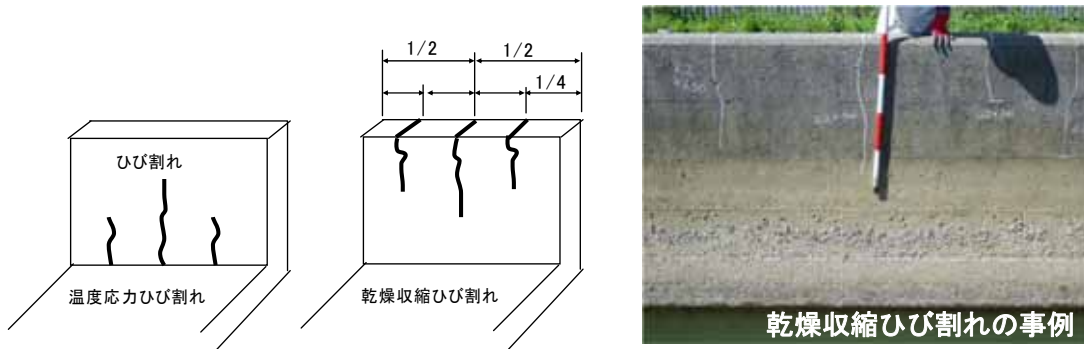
乾燥収縮・温度応力ひび割れ発生位置
